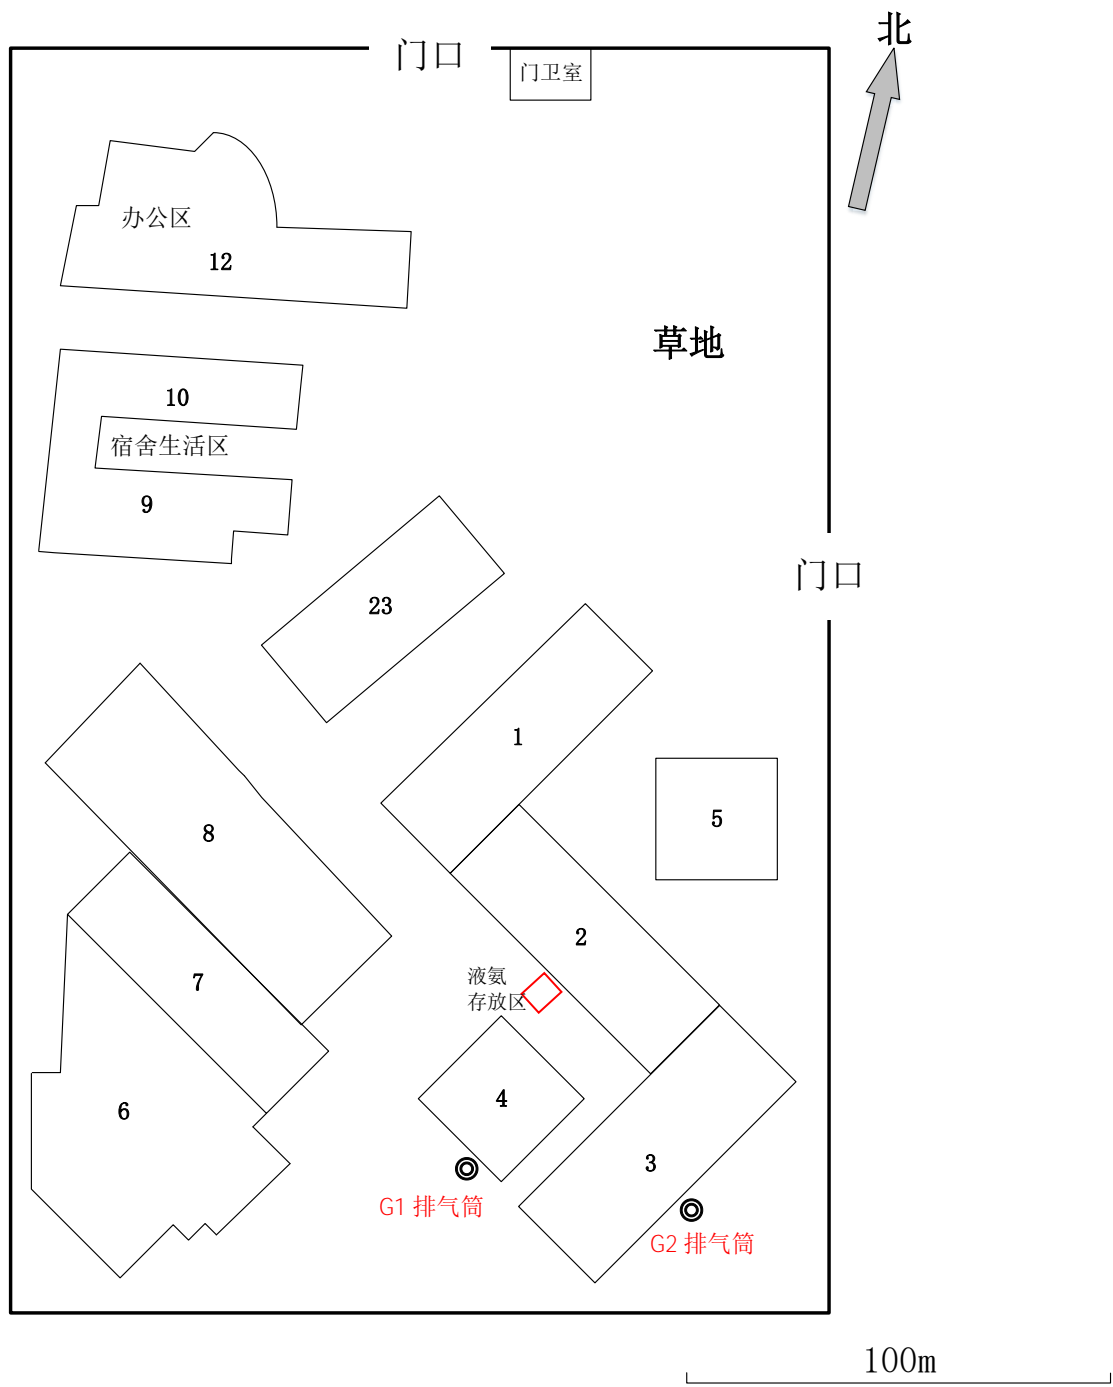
现有工程平面布置总示意图（图中数字代表厂房编号）
